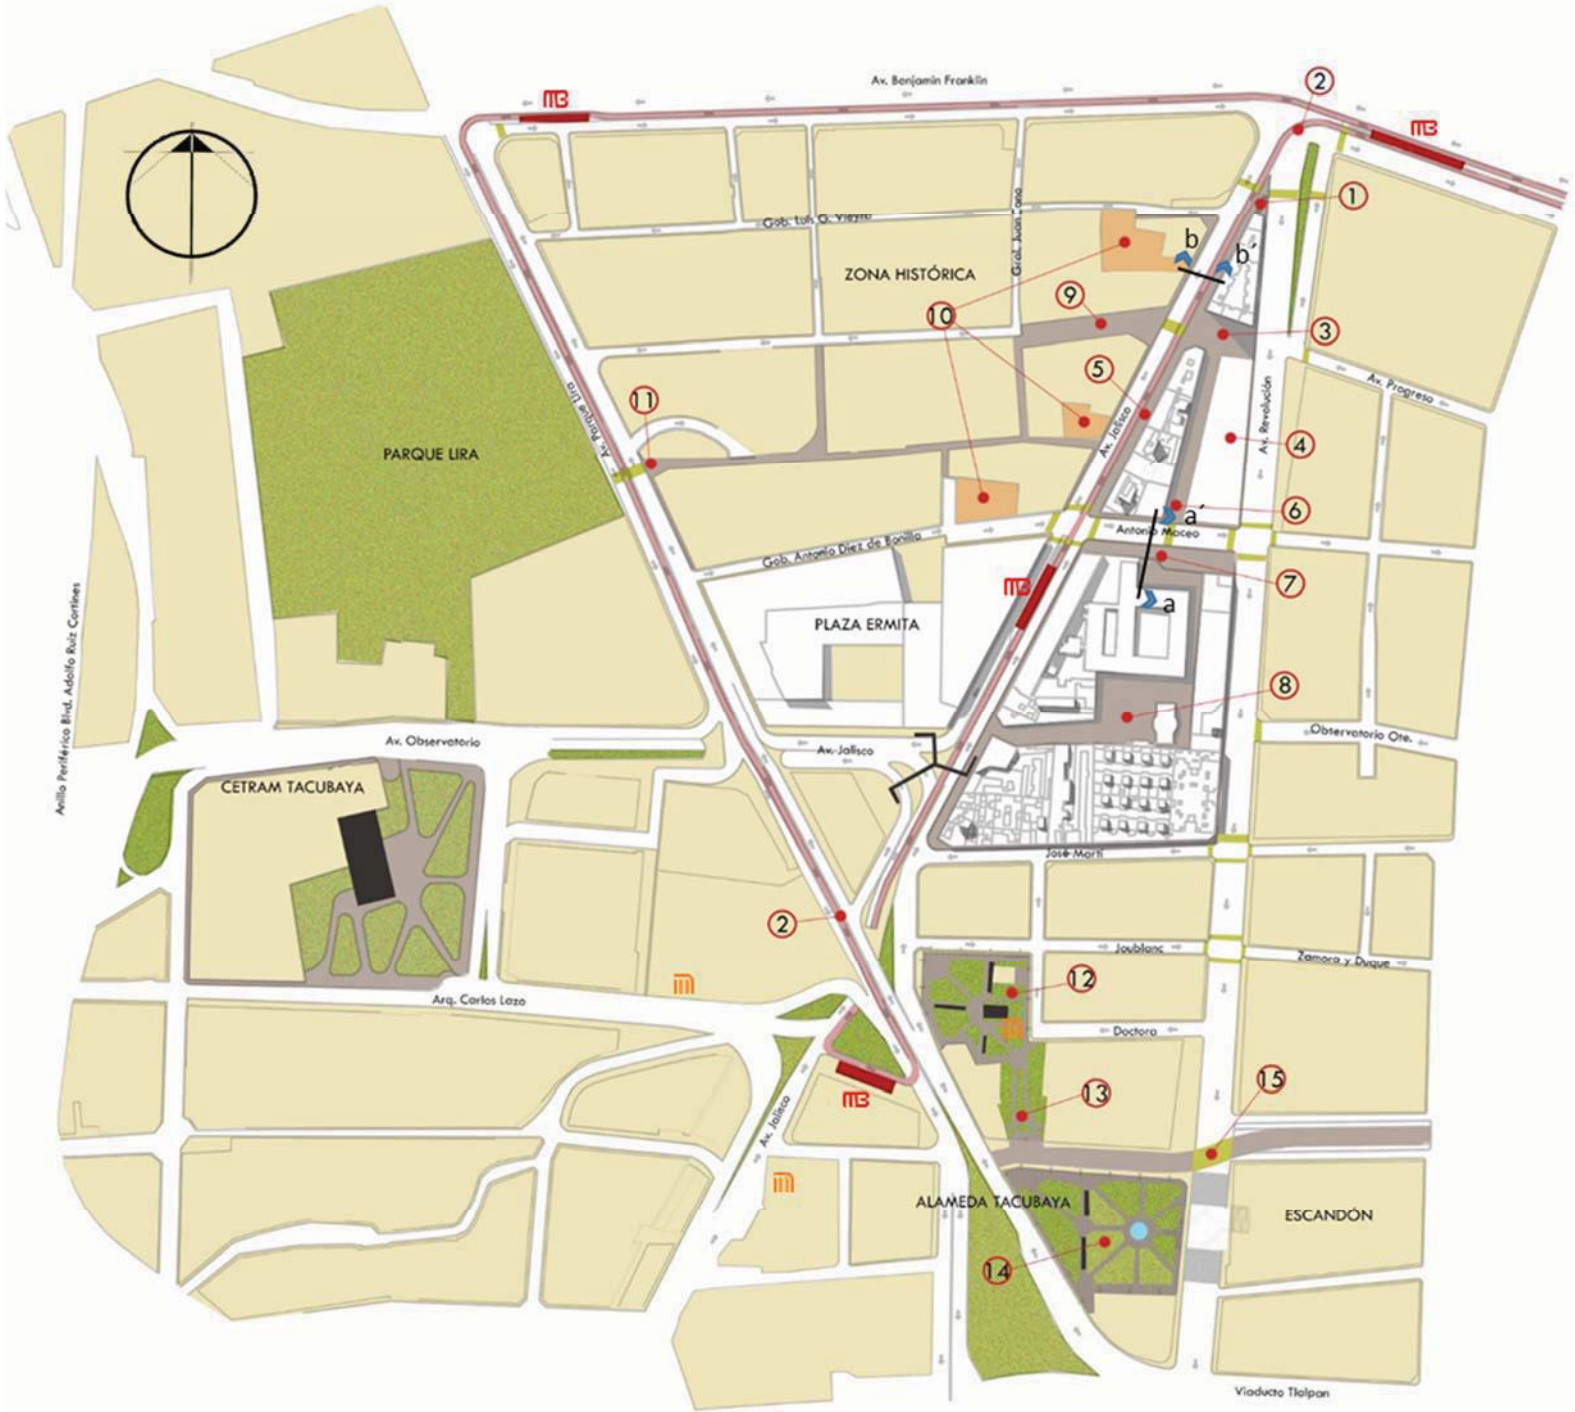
Planta de conjunto, Triángulo y Alameda de Tacubaya. Escenario 1, Opción 4. Elaboración propia.
